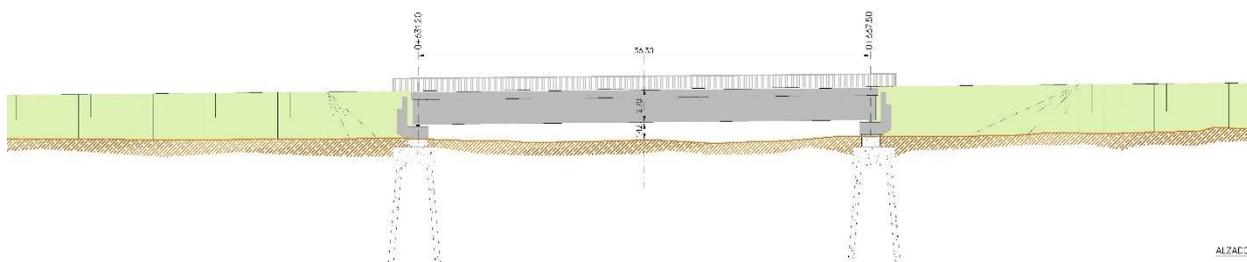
Detalle esquemático de la solución en alzado proyectada para el cruce con el arroyo del Camino de Madrid. Fuente: HEC -RAS y elaboración propia.
